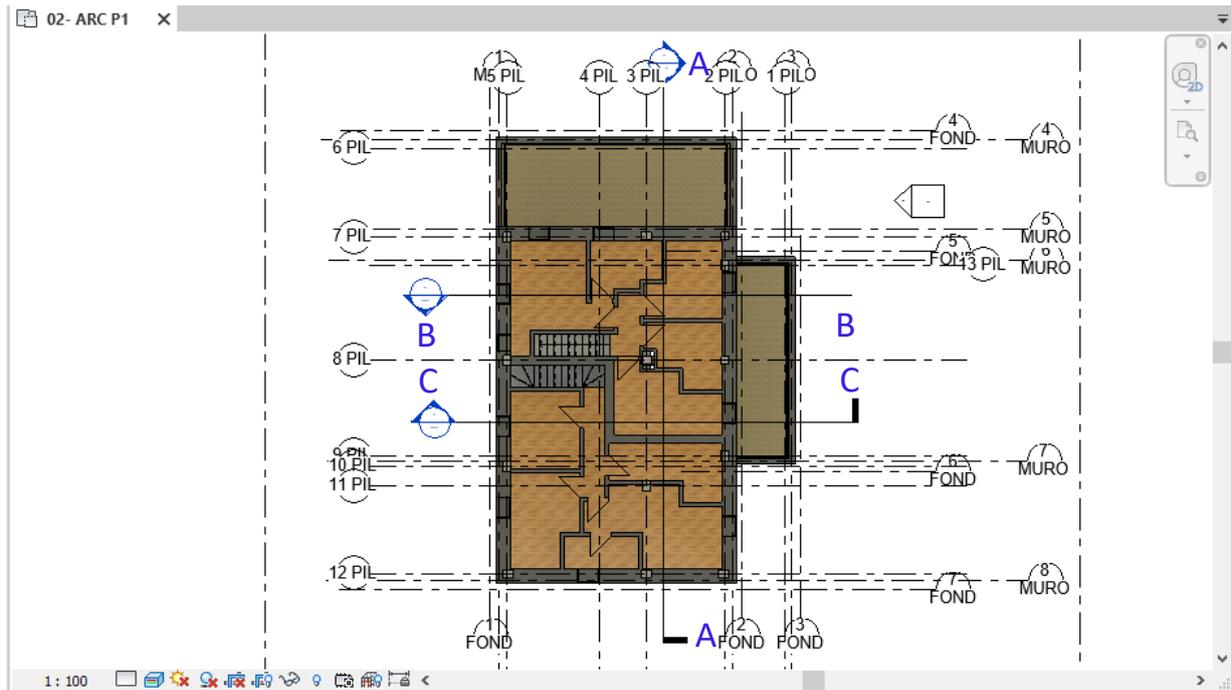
Vista pianta 02- ARC P1: Pianta pavimento piano primo modello architettonico
